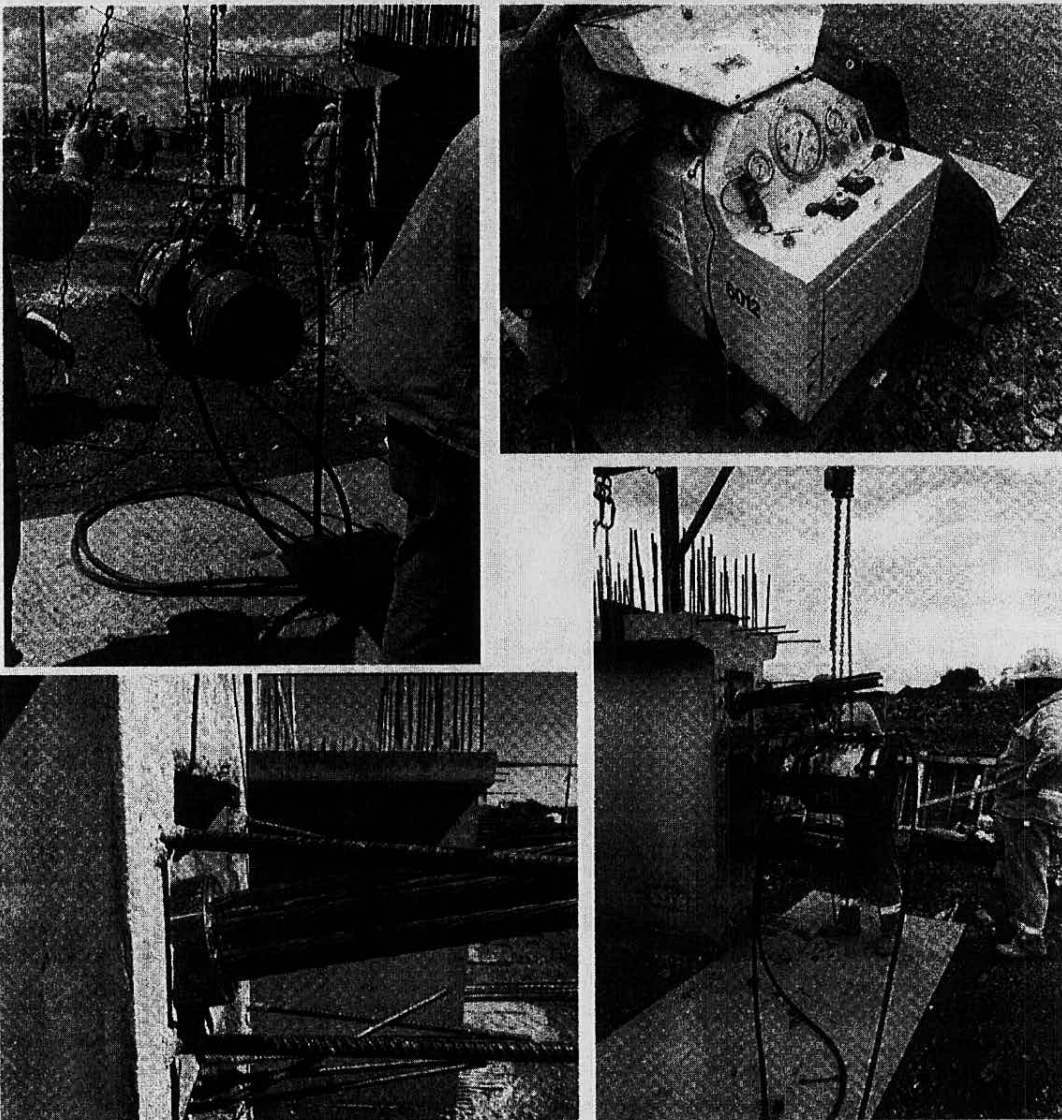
y 10 – Vigas prefabricadas postensadas
